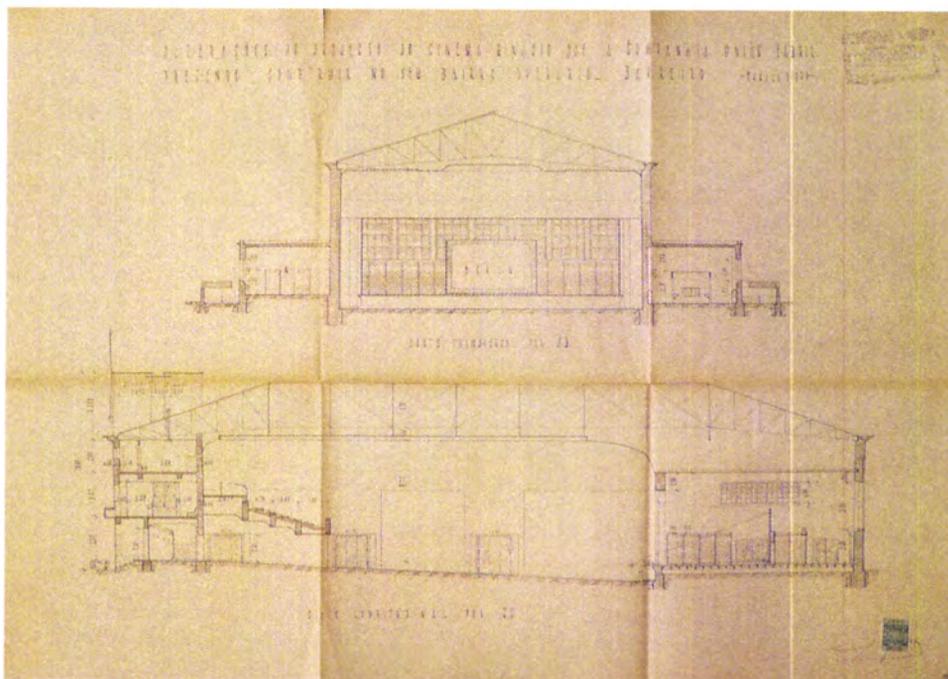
Planta interior do Cinema – Ginásio, onde se destaca a sala de cinema, casa de projecção, balcão e respectivo ginásio ao nível do ecran. Arquivo Municipal – C. M. Barreiro.
